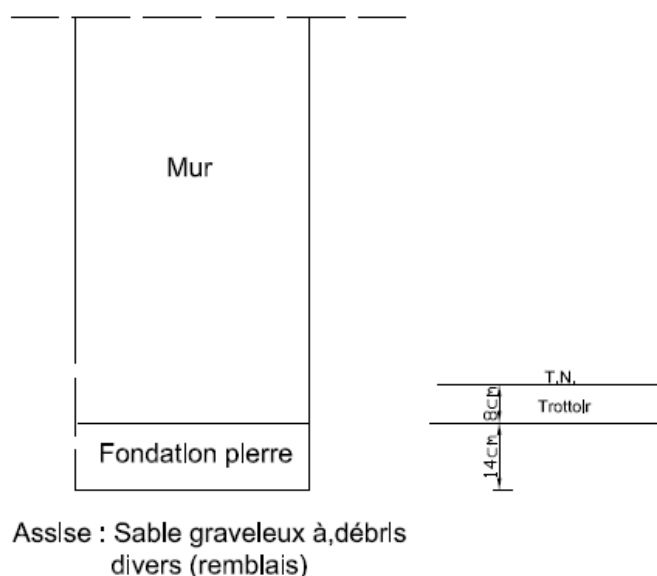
Résultats de la fondation au droit de la fouille RF5
